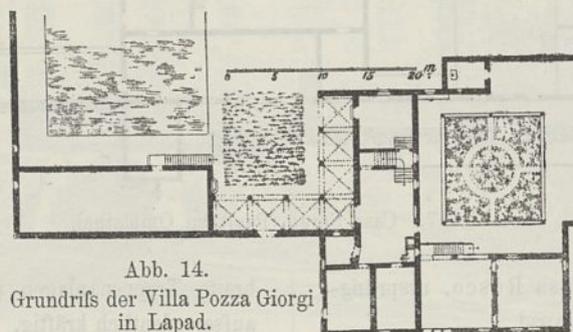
Grundrifs der Villa Pozza Giorgi in Lapad.
